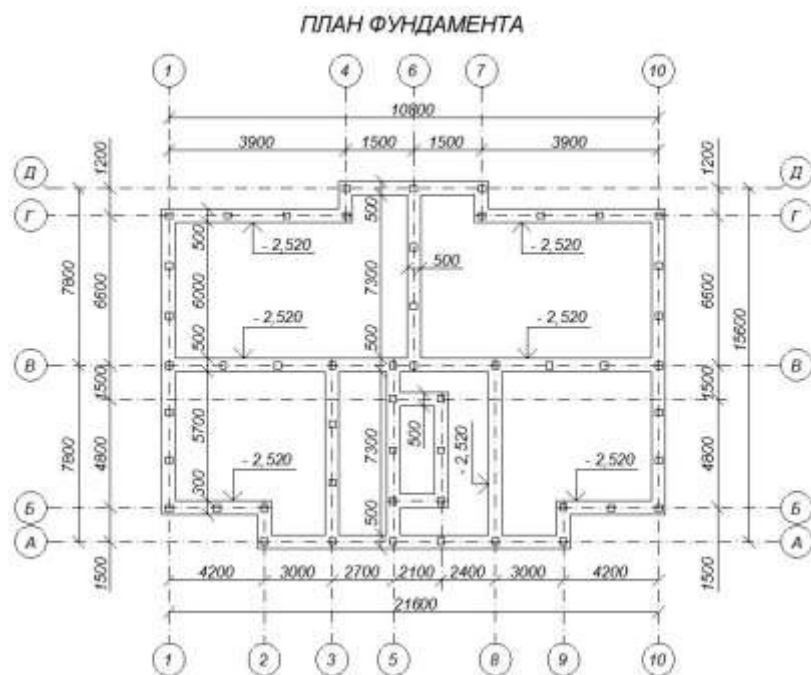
План фундаменту на позначці -2,520 м
